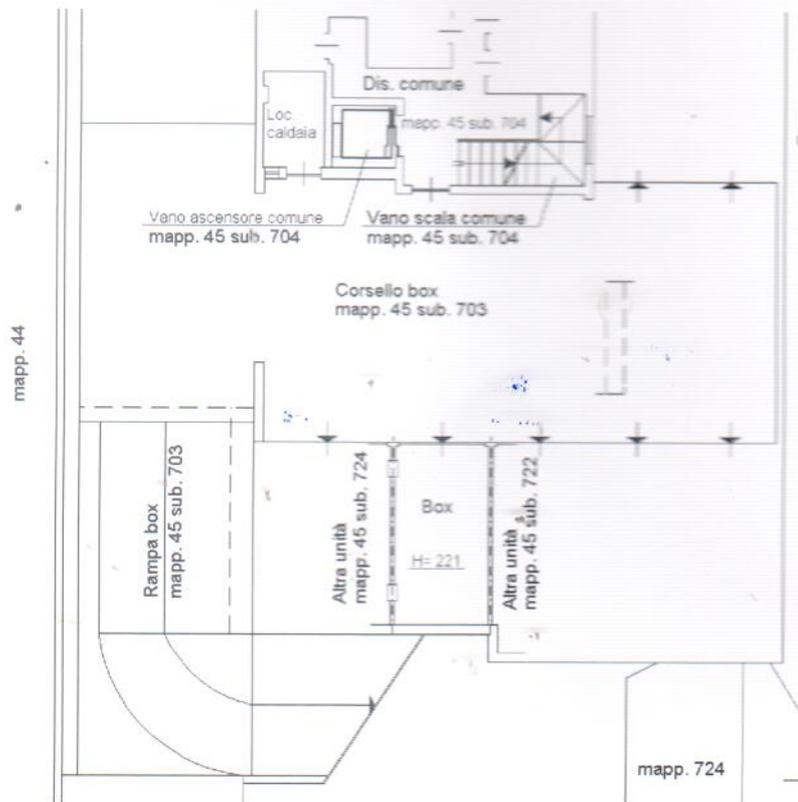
B – Planimetria del Box Auto (evidenziati in giallo) sito in Via della Repubblica 12 Lainate (MI).
